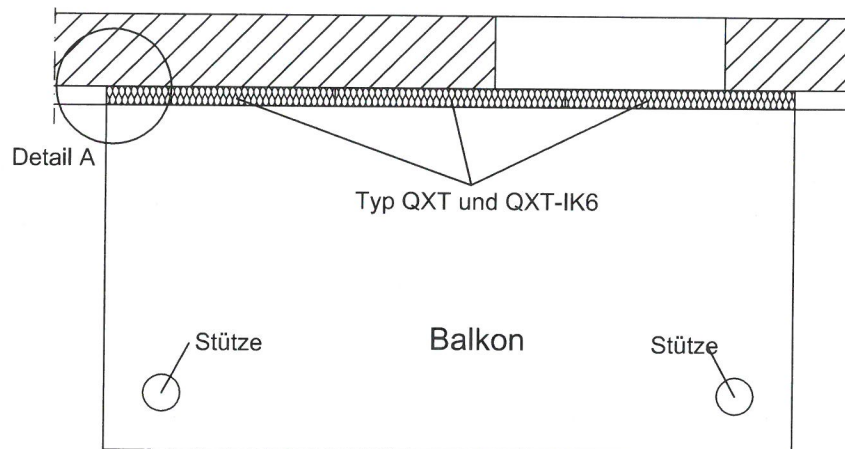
Einbausituation Schöck Isokorb Typ QXT und QXT-IK6
